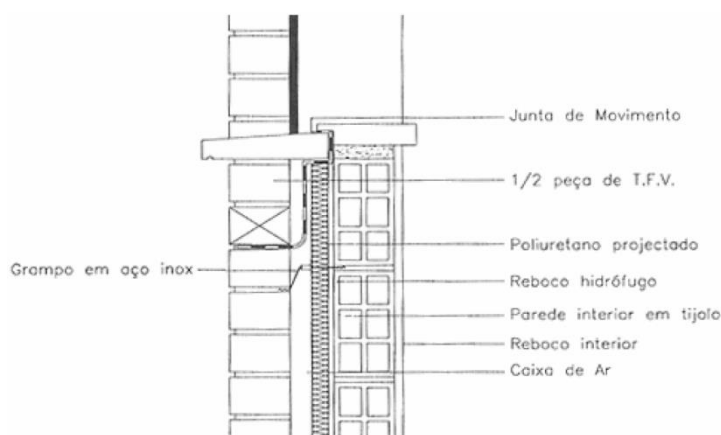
Solução de impermeabilização em zona de peitoril [43]
